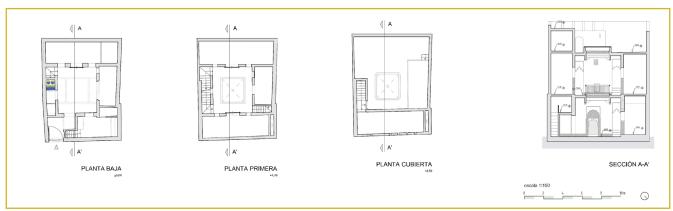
Plantas y corte de casa dar Saka (fuente: Los autores).
